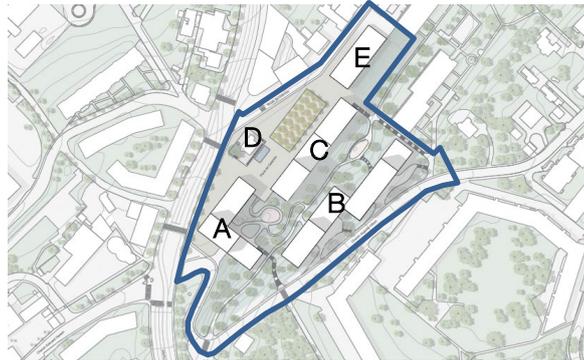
Plan masse du concours de 2016 (source : Group8) En bleu, le PLQ Carantec
